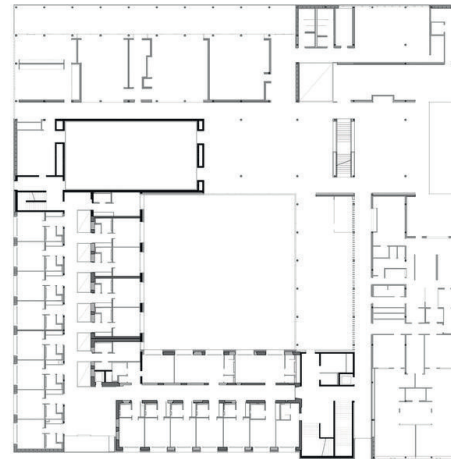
Landwirtschaftsschule Altmünster Grundriss EG
